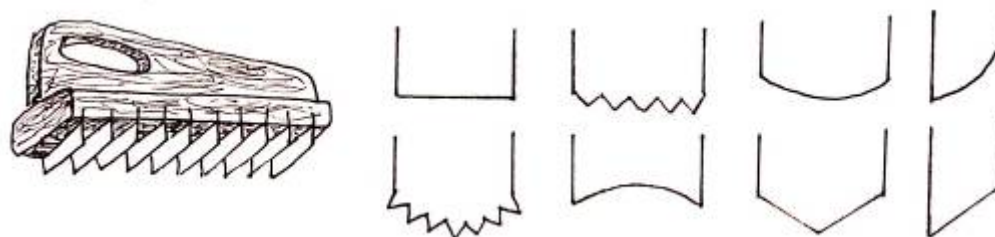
Pily, vlevo pila na měkký kámen, vpravo pila na řezání mramoru
